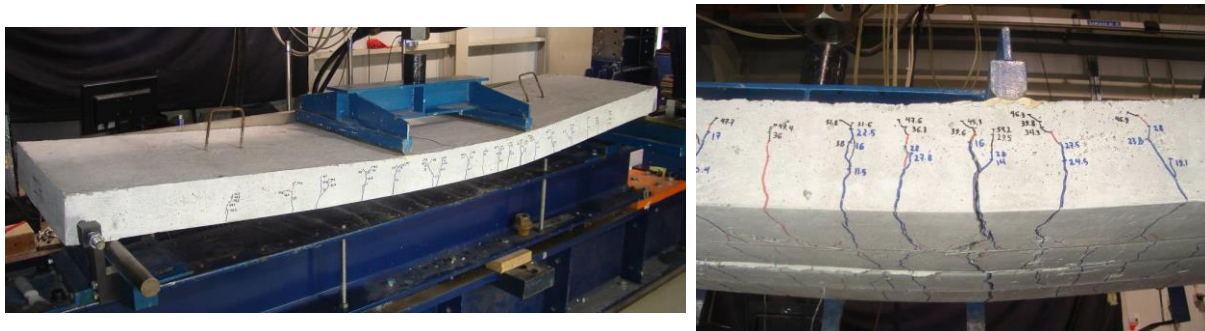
Laje S2L-F1 após o ensaio à rotura e pormenor do modo de rotura.
